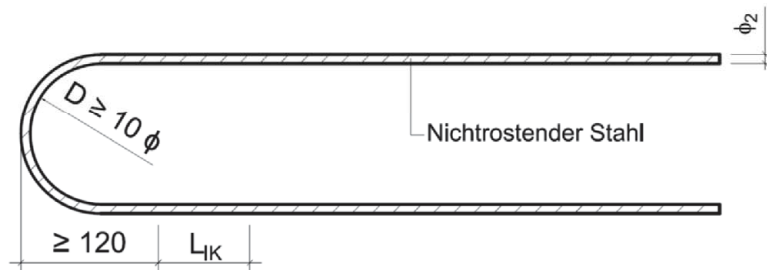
Zugstab für Schöck Isokorb® Typ A und Typ F
